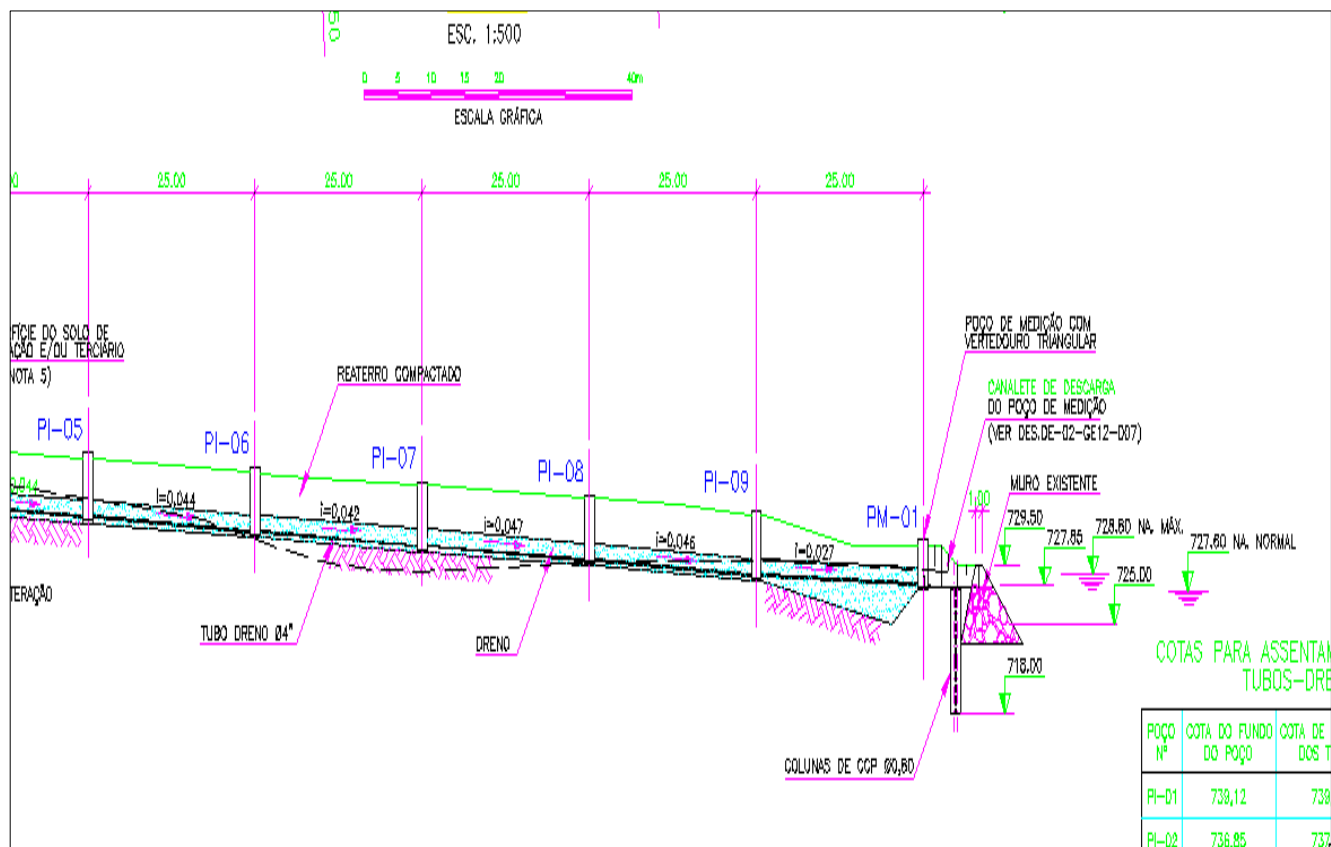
Barragem de Terra – Perfil longitudinal sub - dreno 2/2.
